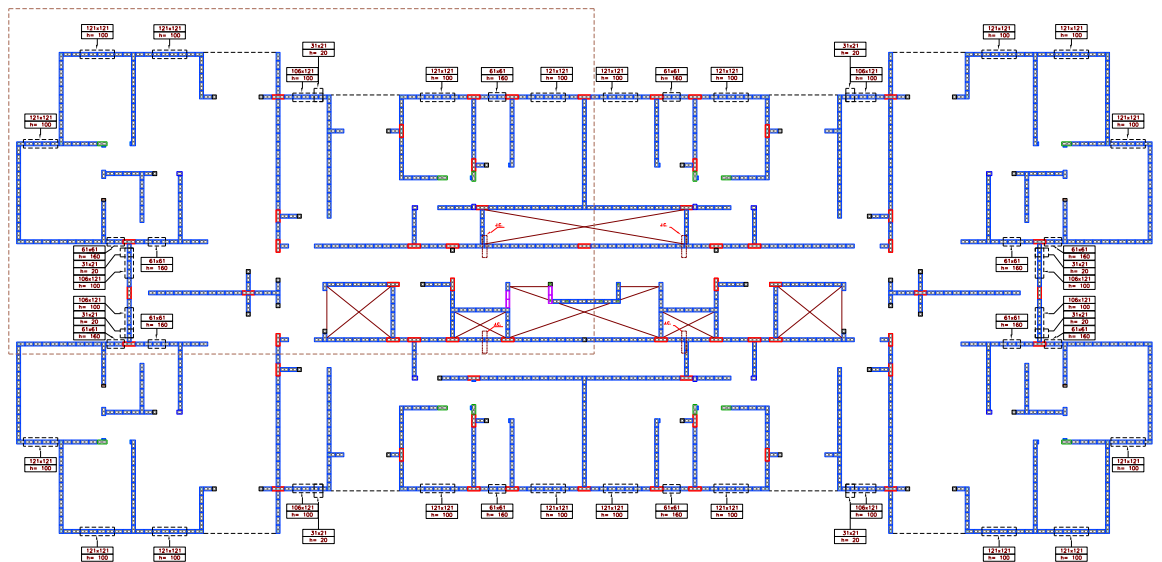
Edifício Way Penha: planta de modulação do pavimento tipo
